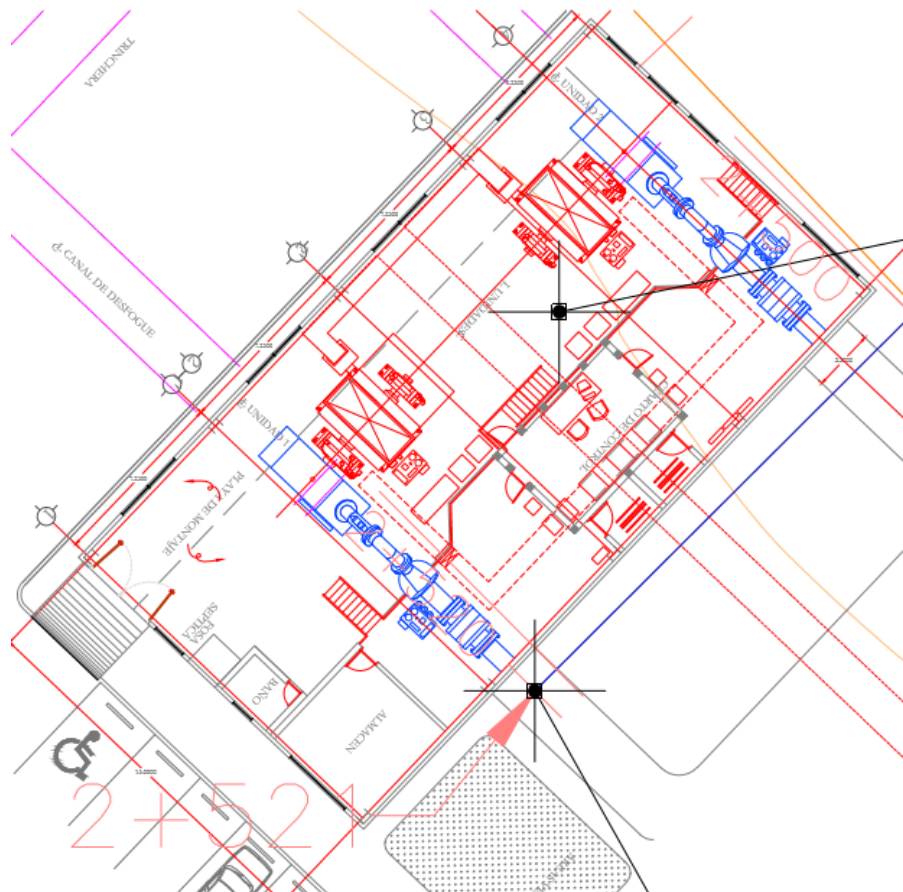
Planta arquitectónica de la casa de máquinas 2.
